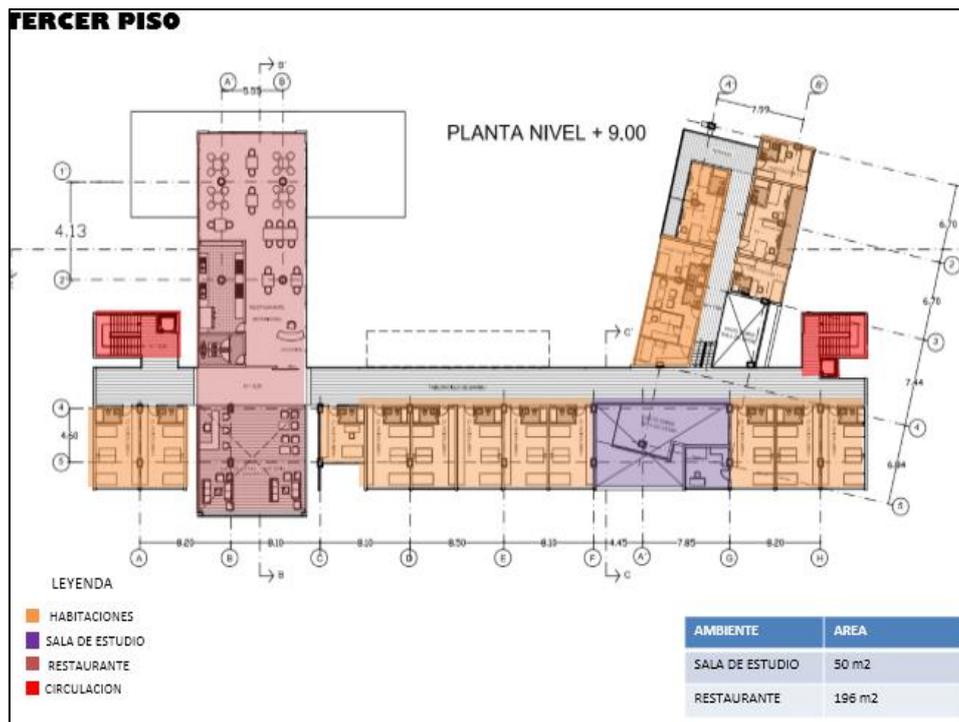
Zonificación 3ra Planta- Residencia Quito. Fuente: Propia
